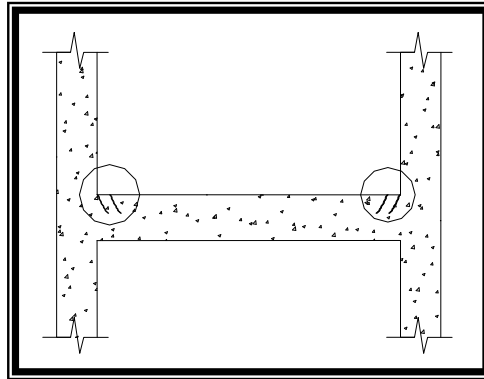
Fisuras perpendiculares al eje de la viga, en la parte superior de los extremos de la viga (Falla por momento negativo en los extremos de la viga)
